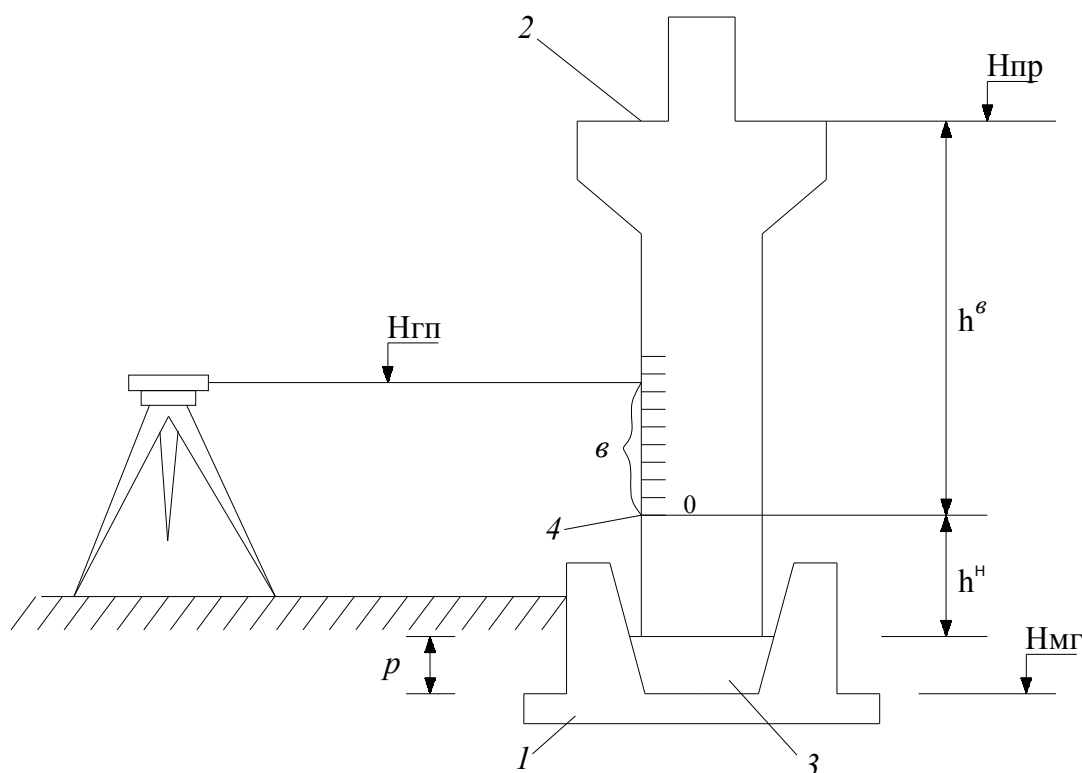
Установка по высоте сборной железобетонной колонны:
